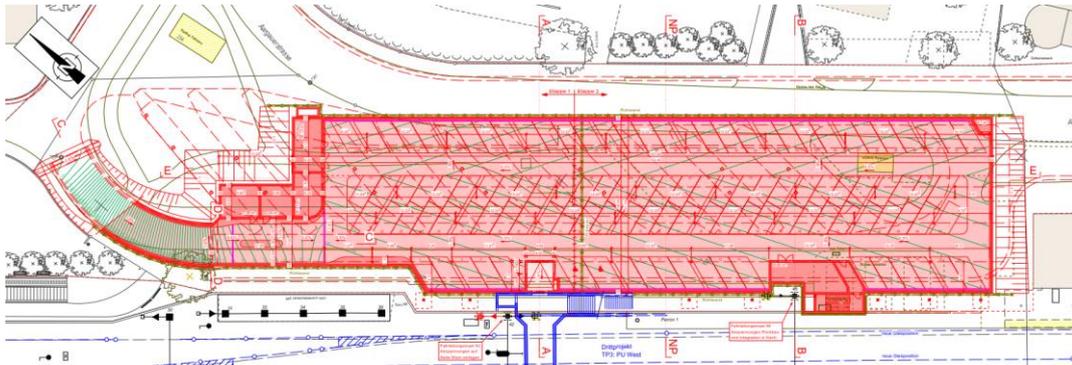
Situationsplan Tiefgarage mit 112 PP
